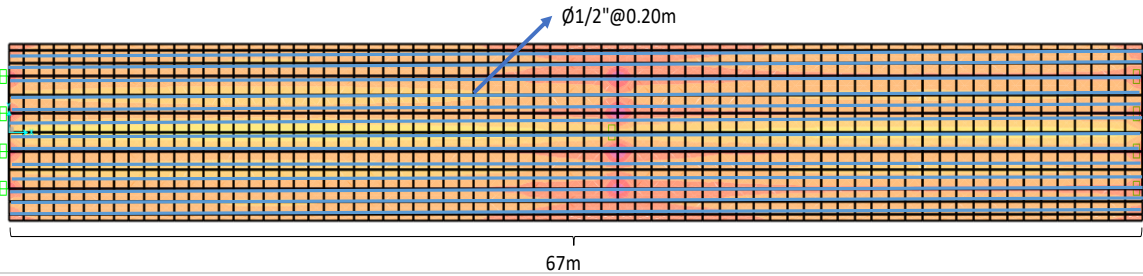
Distribución de acero de refuerzo inferior longitudinal en losa
